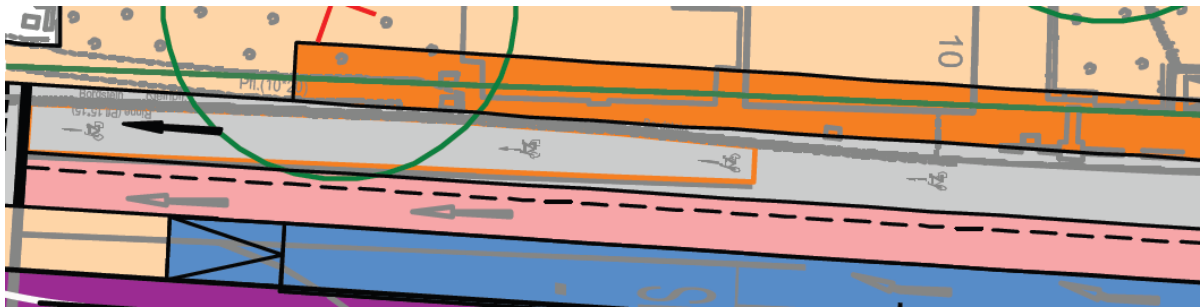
Lageplan Abschnitt 3 Radverkehrsführung
